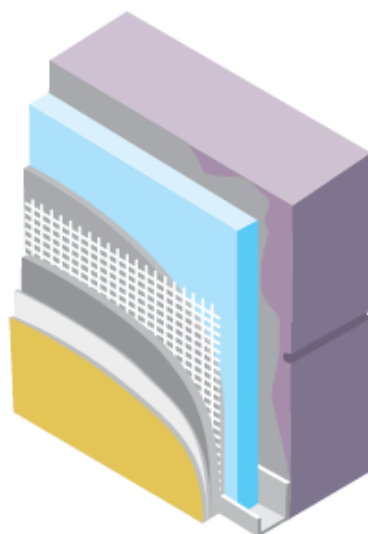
esquema da solução preconizada para revestimento de fachada pelo exterior – webertherm extra
